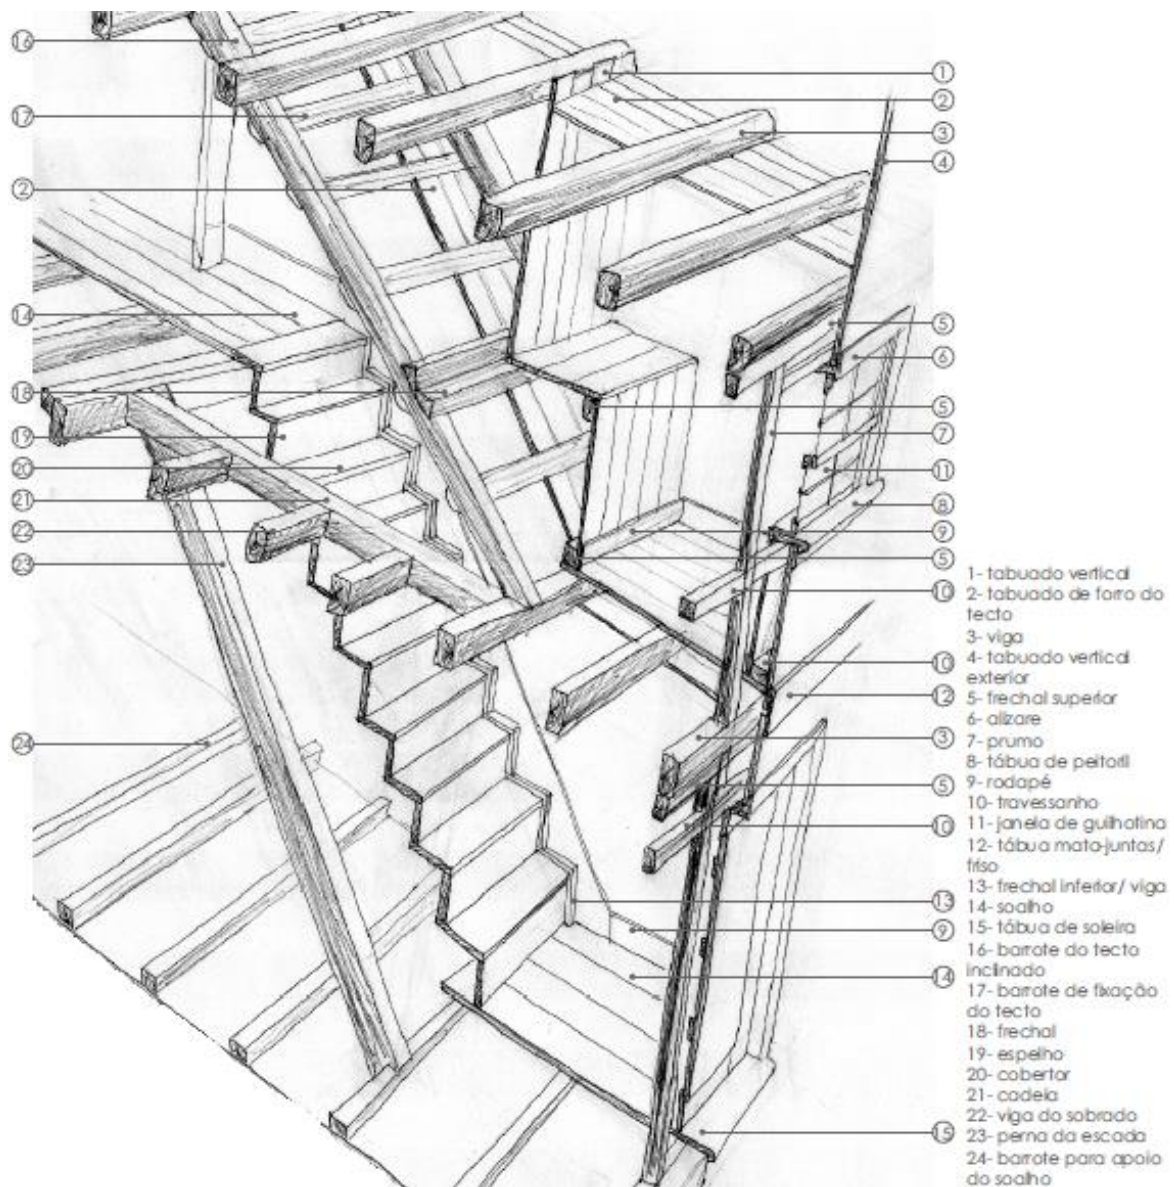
Pormenor tipo da escada interior (fonte: Moutinho (2007))
